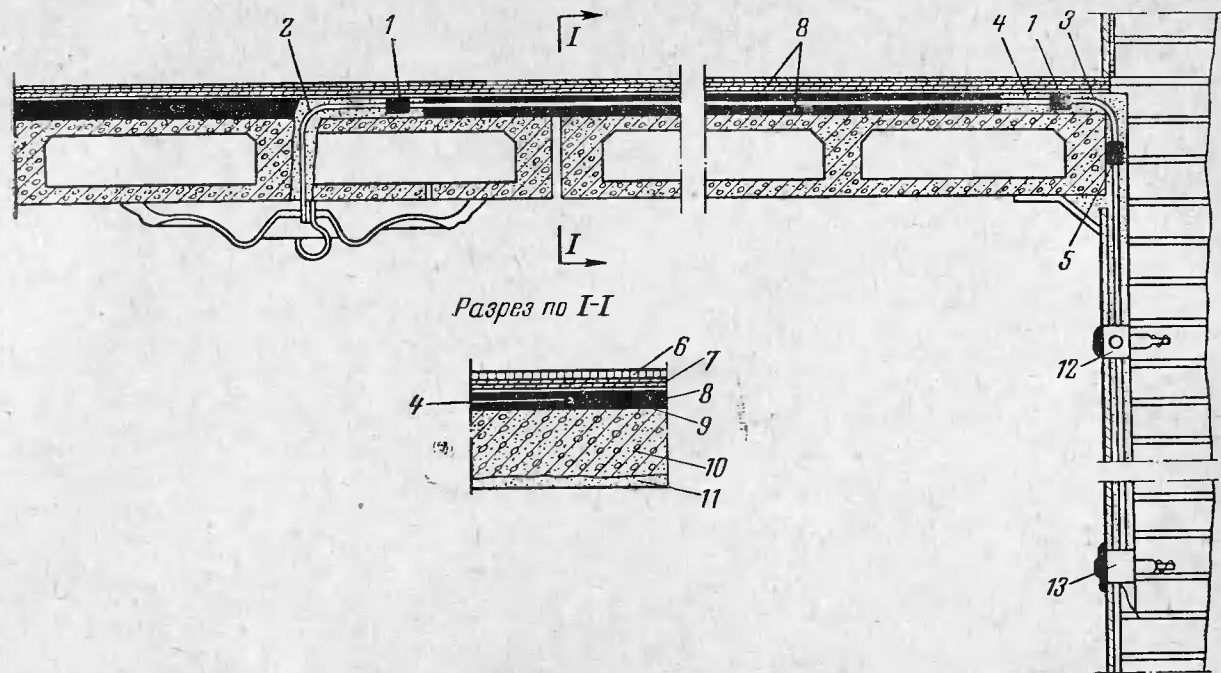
Прокладка стеклянных труб по гладким плитам сборных-железобетонных перекрытий.
